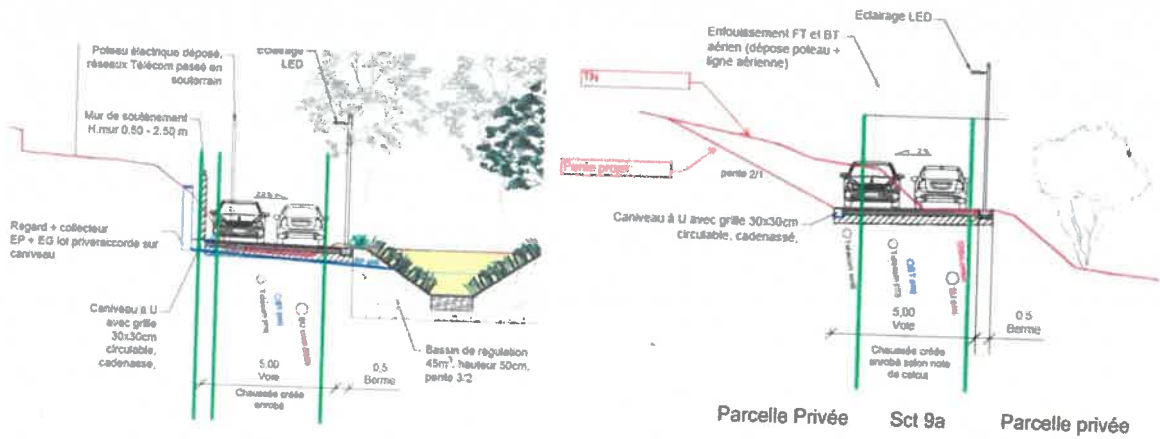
coupe de principe de la future voie des Maoupas et élargissement au niveau du bassin
